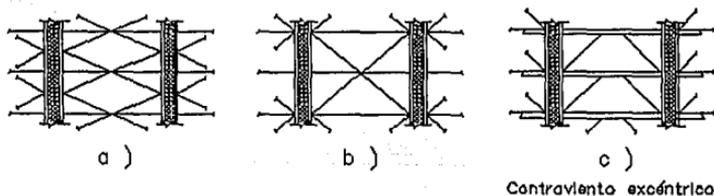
Ejemplos de contraventeo de acero para la reestructuración de marcos de concreto.
